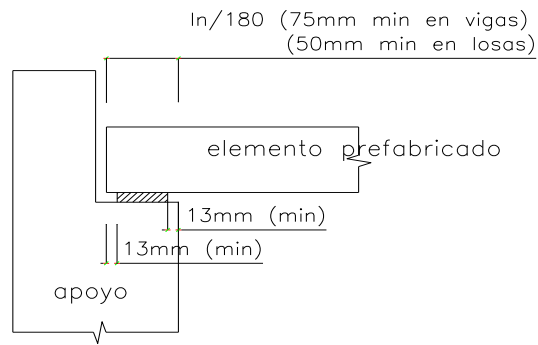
Longitud de apoyo de un elemento prefabricado.
